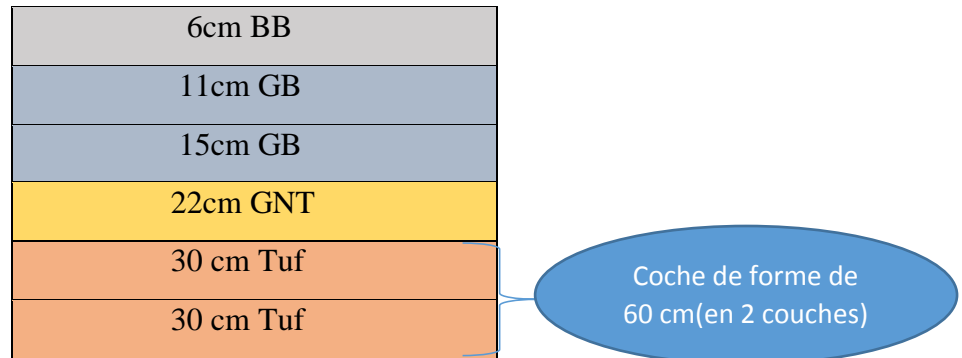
La structure de la chaussée proposée par la méthode CTPP
